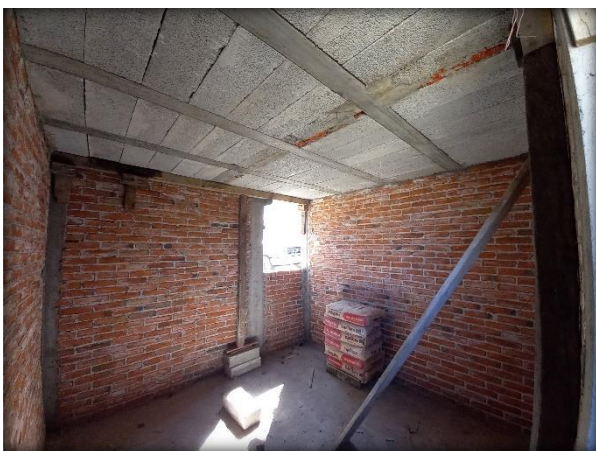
Losa de vigueta y bovedilla. Elaboración Propia.
